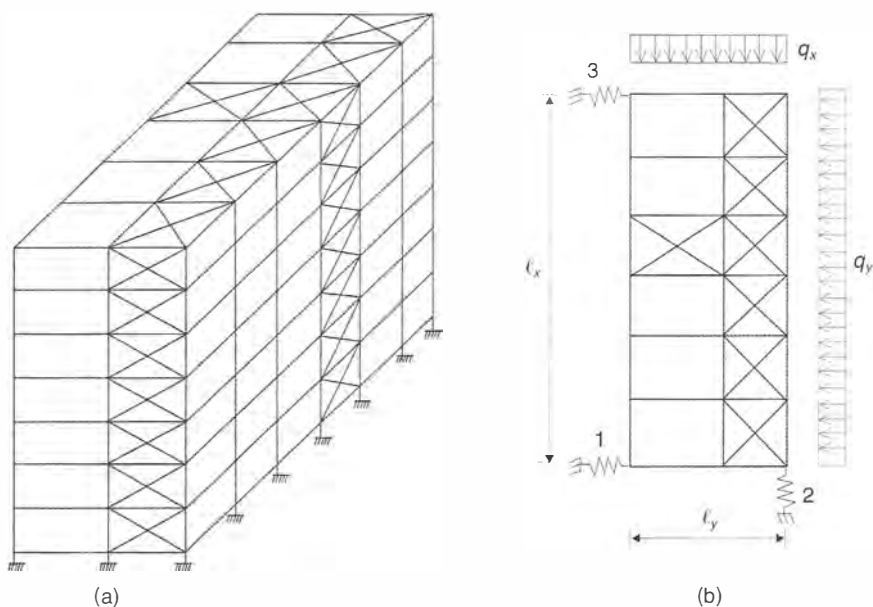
Edifício com contraventamentos treliçados: (a) esquema estrutural tridimensional; (b) planta do andar-tipo.
